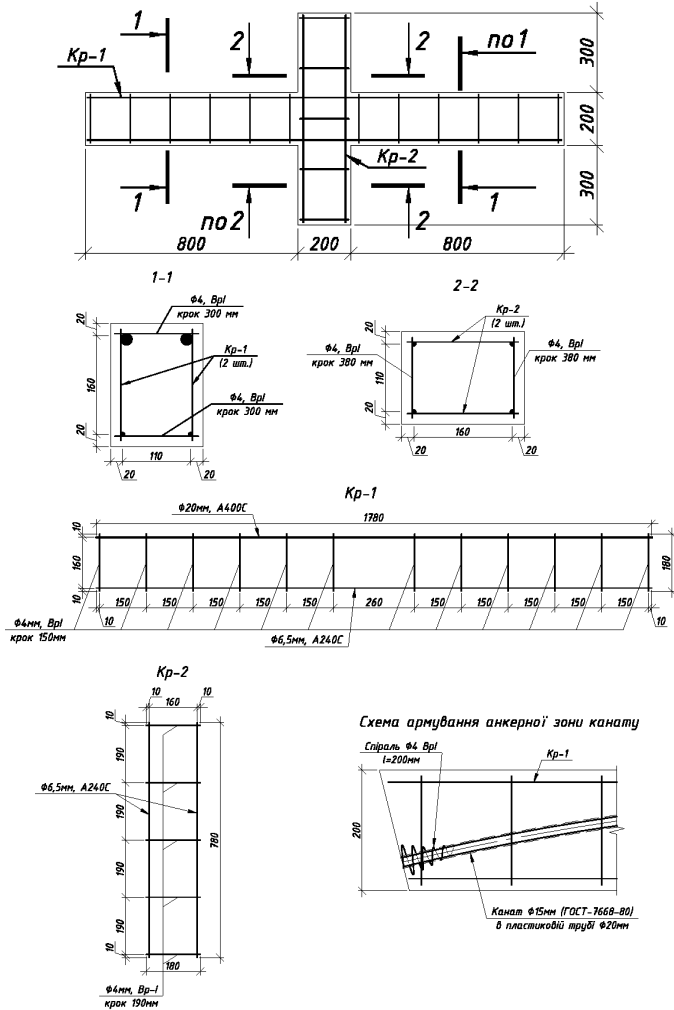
Схема армування зразків не напружуваною та поперечною арматурою
